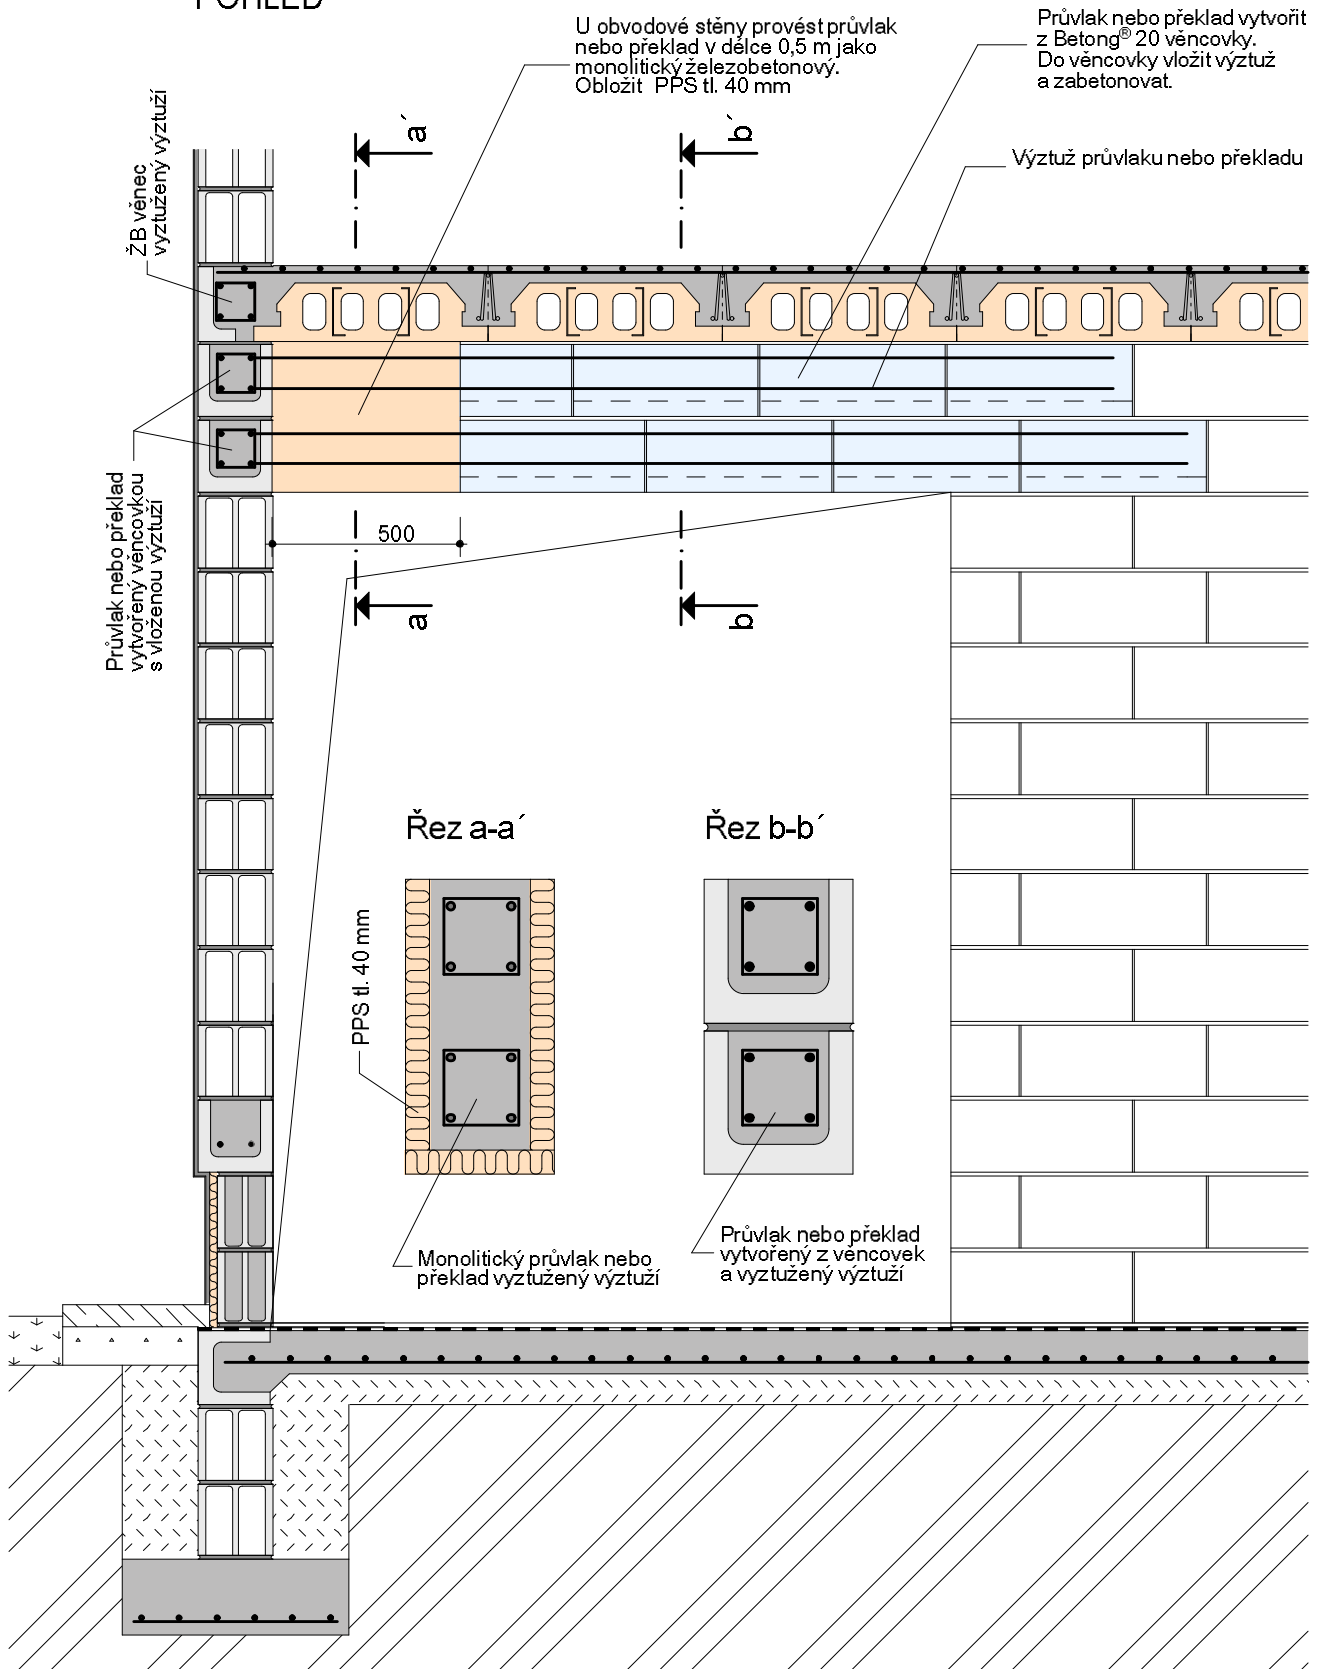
STYK OBVODOVÉ STĚNY A STROPU
